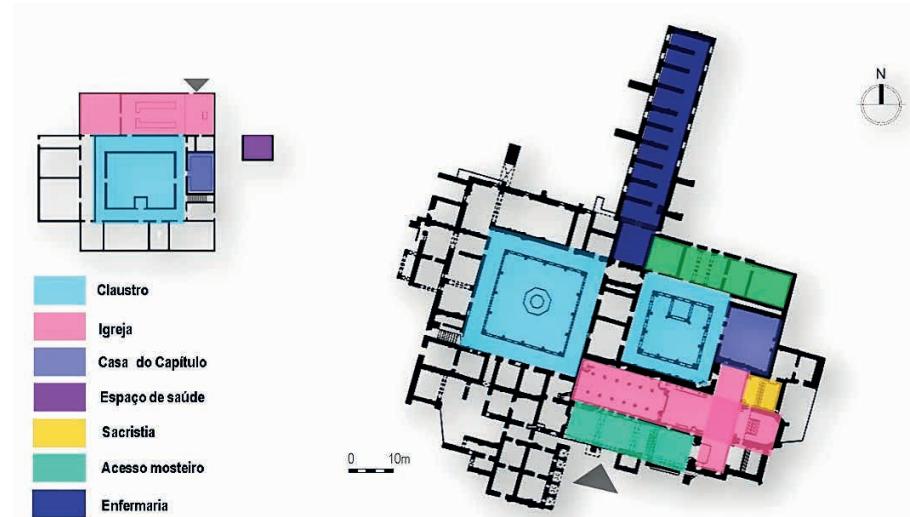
Planta do piso térreo do mosteiro. Fonte: planta desenhada por M. C. Tereno com base em Ana Tavares Martins.
